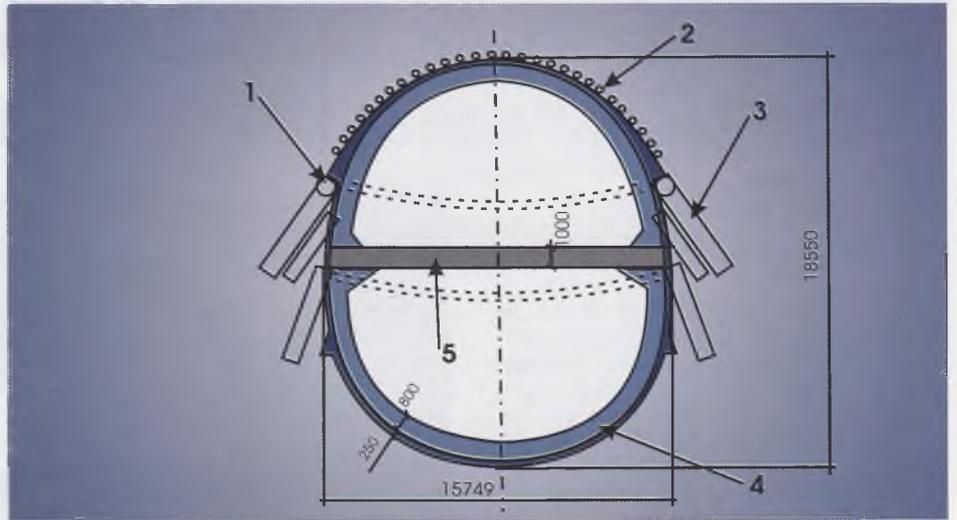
Поперечное сечение 2-ярусного тоннеля Оуме: 1 - грунтцементные столбы; 2 - экран из труб; 3 - наклонные микросваи; 4 - обделка из монолитного бетона; 5 - промежуточное перекрытие
